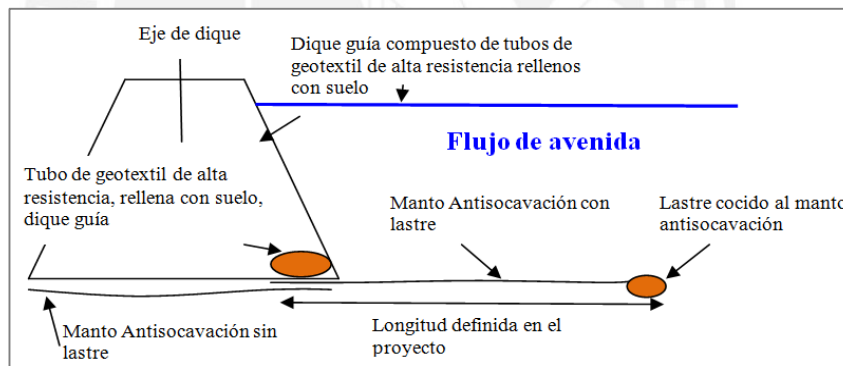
Esquema de colocación de manto antisocavación (Fuente: Proyecto de Ingeniería de Detalle)
